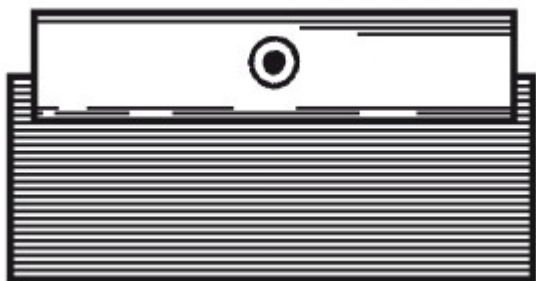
Специальный шпатель для заделки швов на перекрытиях
